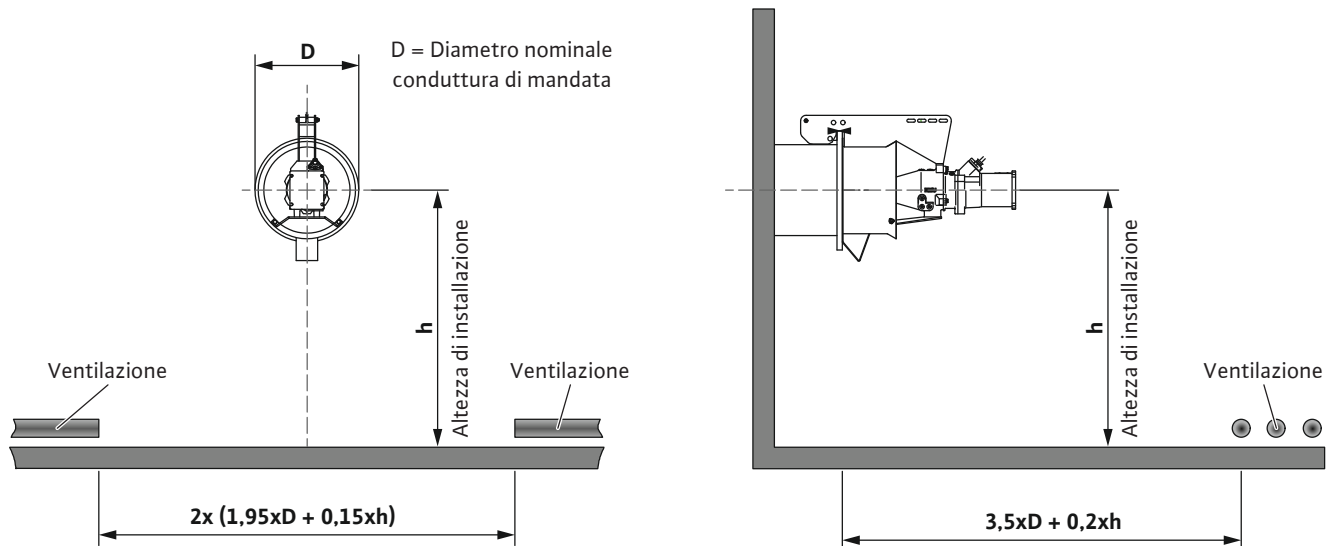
Distanze di sicurezza minime dalla ventilazione
